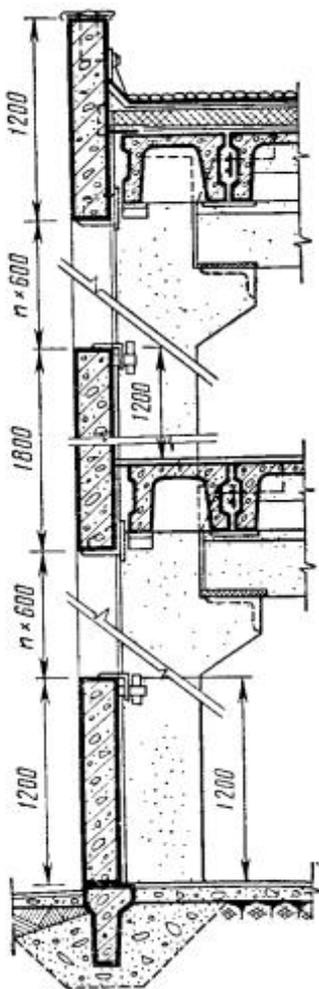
Фрагмент фасада и узлы крепления стеновых панелей к колоннам каркаса многоэтажного промышленного здания
